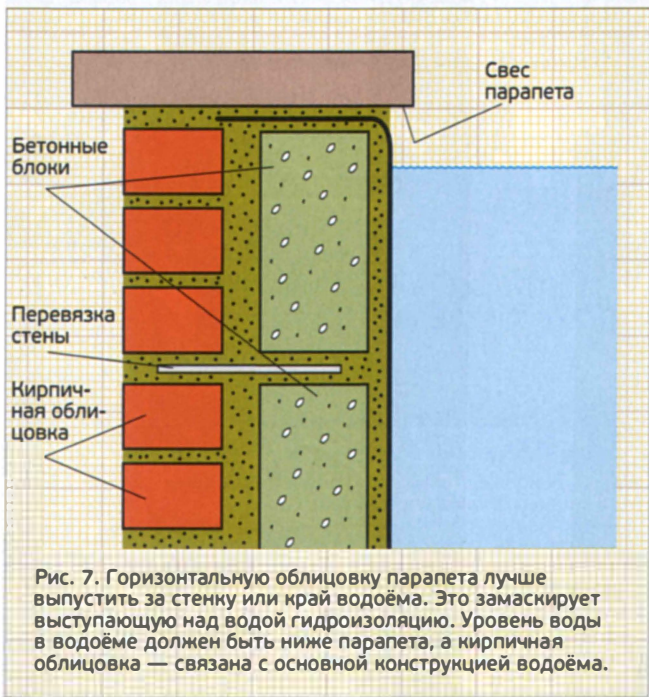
Горизонтальную облицовку парапета лучше выпустить за стенку или край водоёма. Это замаскирует выступающую над водой гидроизоляцию. Уровень воды в водоёме должен быть ниже парапета, а кирпичная облицовка — связана с основной конструкцией водоёма.
